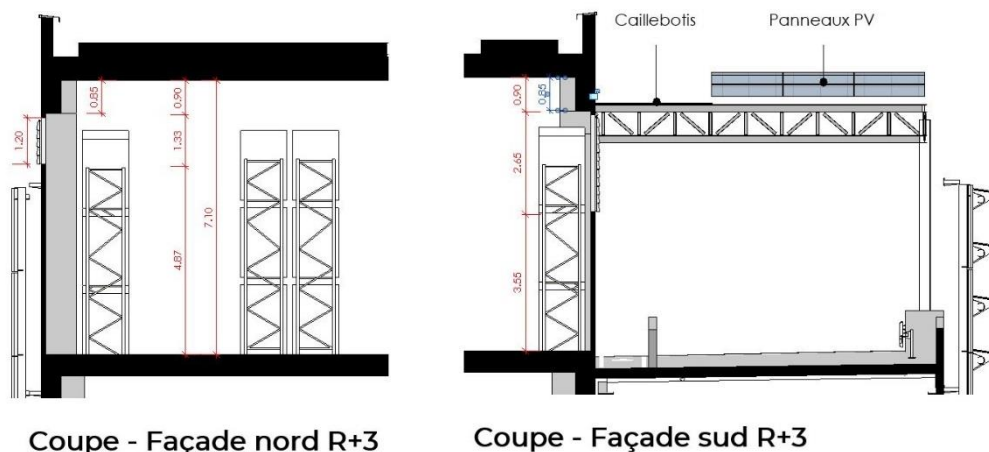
Vues en coupe en façades NORD et SUD d'une cellule du R+3 – Position des ouvrants en façades
